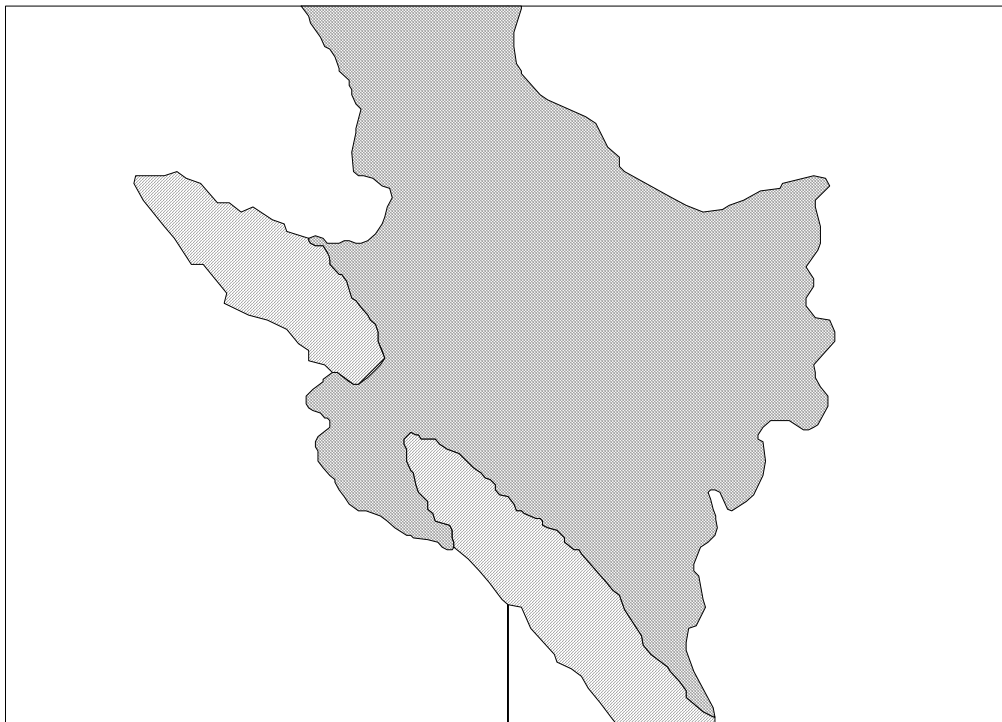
1C1-8 のひび割れ図
